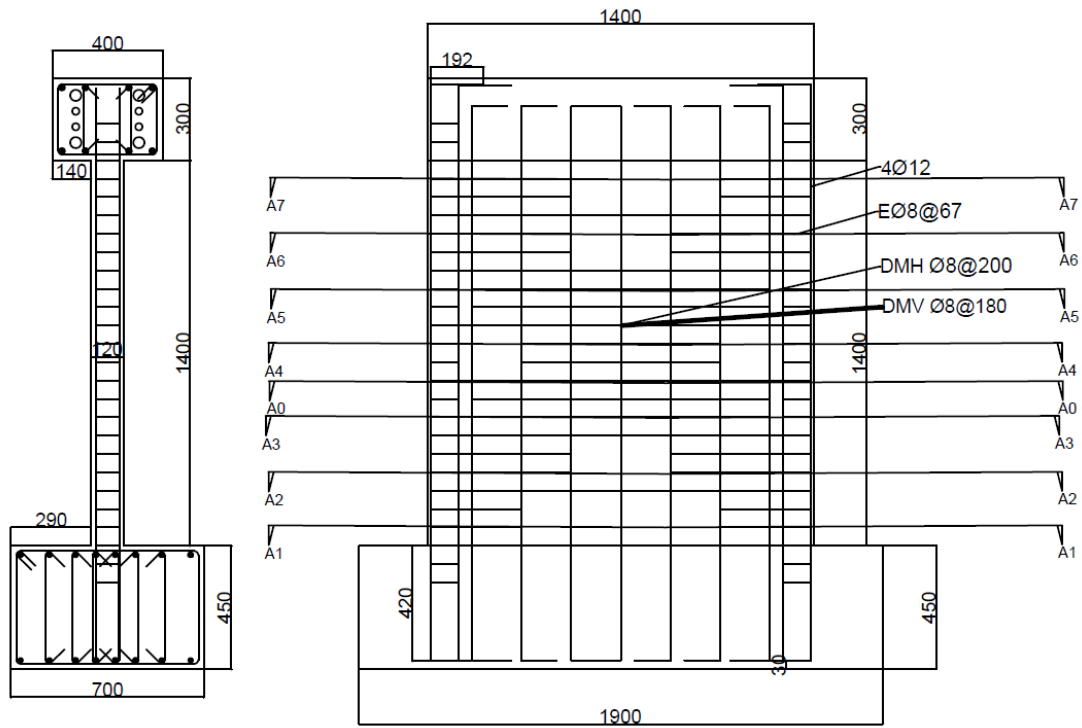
Vista lateral y frontal del muro alternativo.
